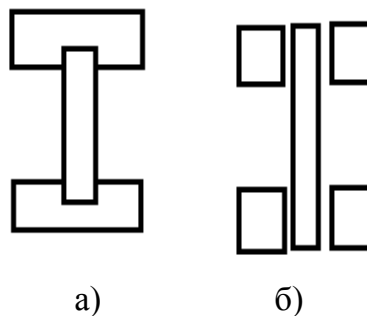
Вид поперечного сечения балок со стенками из фанеры (а) и OSB (б)
